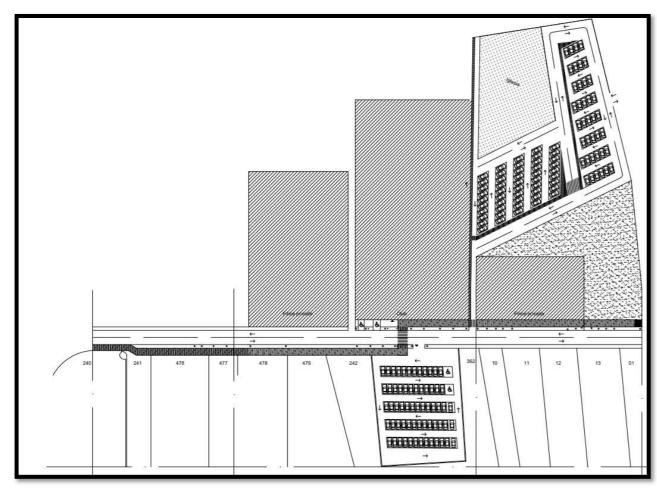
Planta zona después de la actuación. Fuente: Elaboración propia
